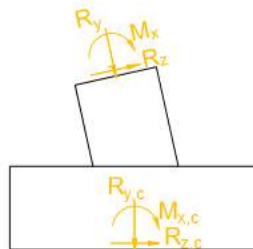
Reacciones en la base de cimentación inclinada. Plano YZ.
